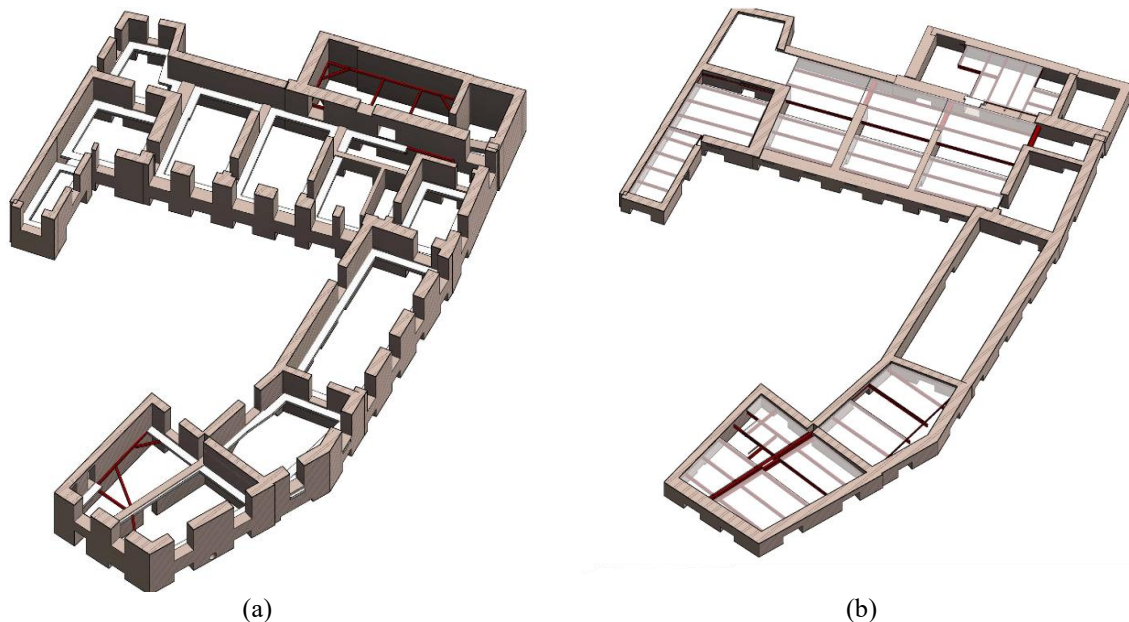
Soluções de contenção de fachada para (a) os pisos correntes (banda de laje de BA) e (b) o último piso (laje mista).
